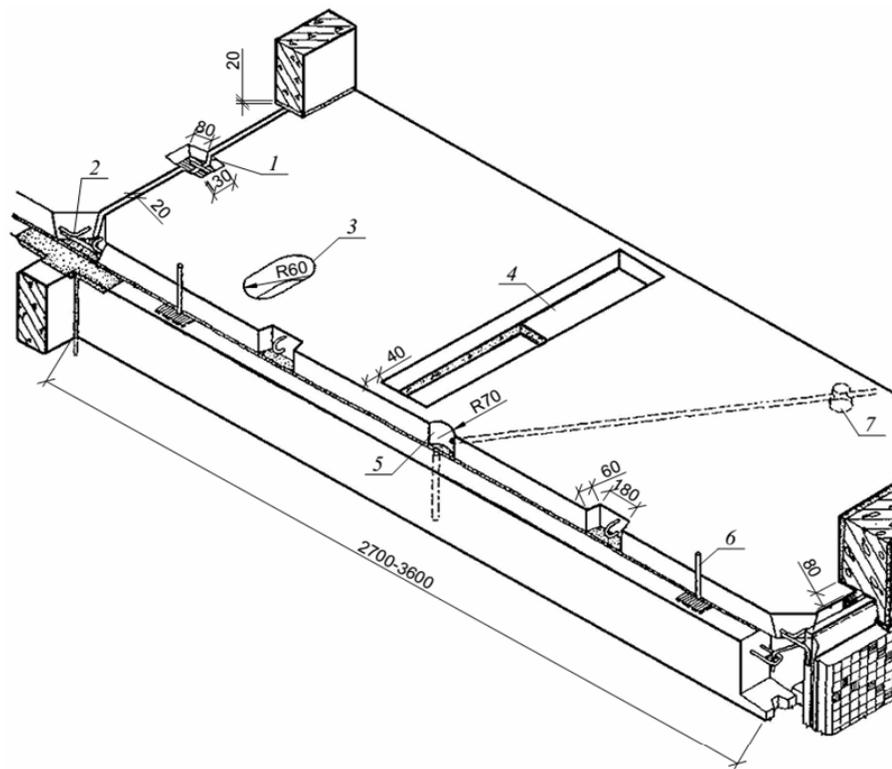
Плита перекрытия железобетонная сплошная для жилых зданий с малым (2,7...3,6 м) шагом несущих стен (серия 1.143-2): 1 — подрезки с закладными уголками $75 \times 50 \times 8$; 2 — угловые арматурные выпуски; 3 — отверстие для инженерных коммуникаций; 4 — отверстие для вентиляционного блока; 5 — выкружка и канал диаметром 25 мм для электропроводки; 6 — фиксатор-шпилька М16; 7 — ниша диаметром 60 мм
